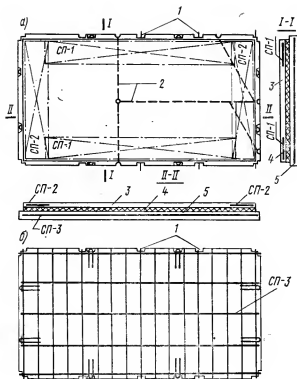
Комплексная легкобетонная панель перекрытия
